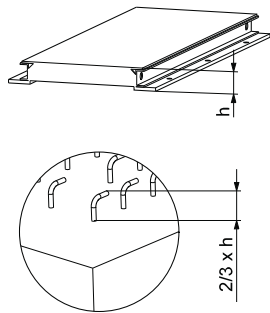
Усиливающие стальные стержни, устанавливаемые в фундамент
